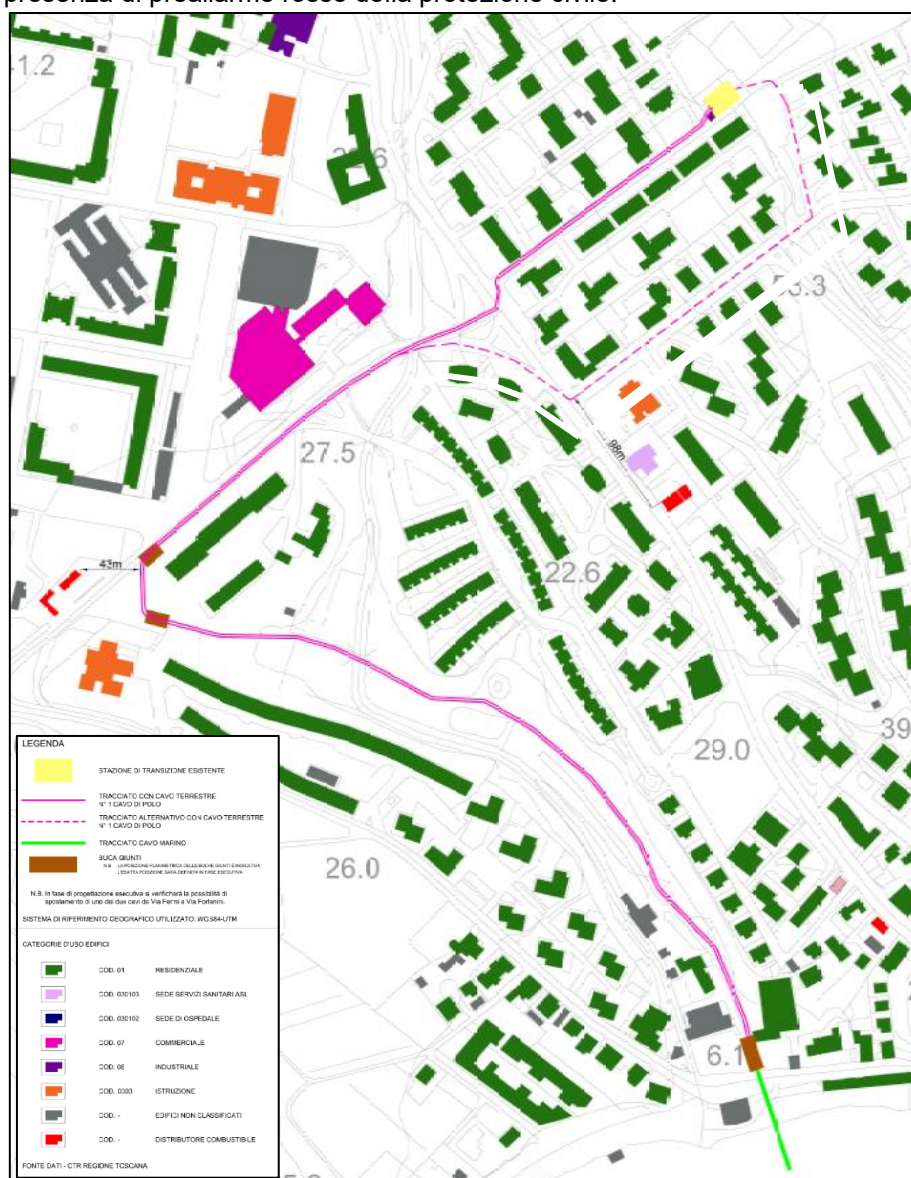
Estratto planimetria DVHR10002BCC00536 – Salivoli (Piombino)
